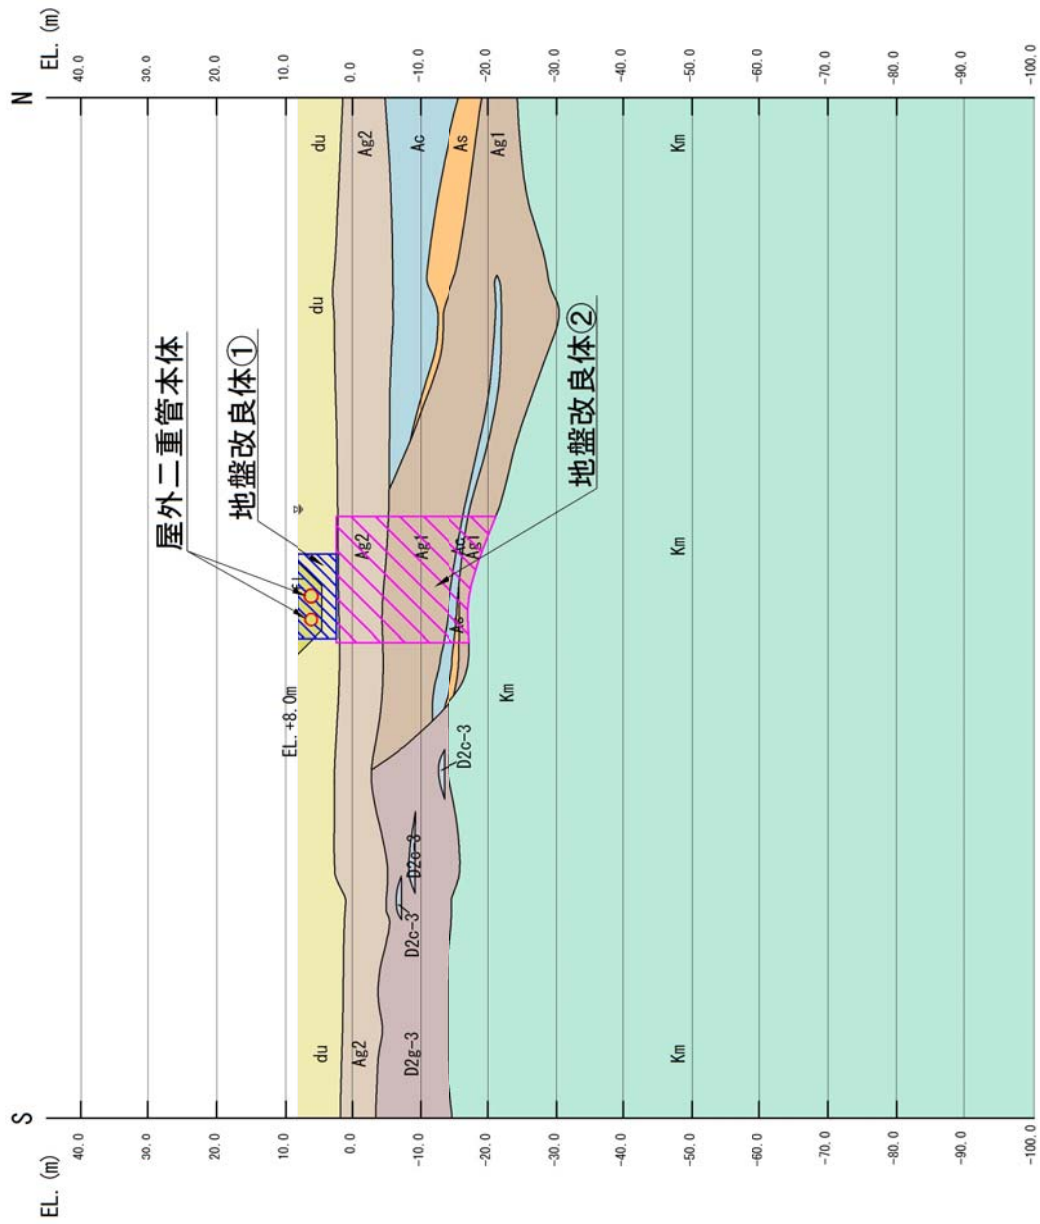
(4) 屋外二重管基礎の評価対象断面図 (C'-C' 断面・地盤改良体基礎構造部)
